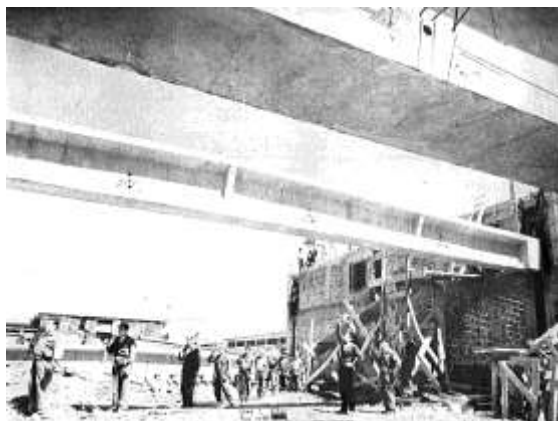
(der). Fábrica y Manufacturas Sumar, Santiago de Chile. Fotografía detalle vigas prefabricadas en hormigón armado. En: Revista Técnica y Creación N°8. Instituto de Edificación Experimental Universidad de Chile, Santiago, 1965.
